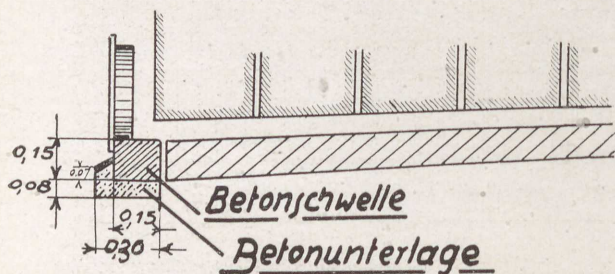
Die Betonbordschwellen als Betonfahrbahn und als Fahrbahn für die Straßenbaumaschinen
